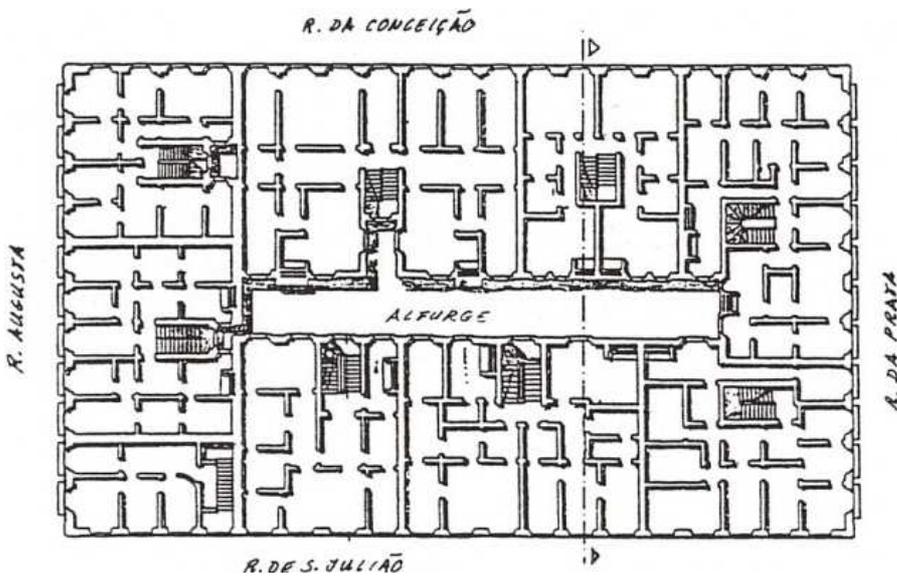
Planta completa do quarteirão ao nível do 1º andar
